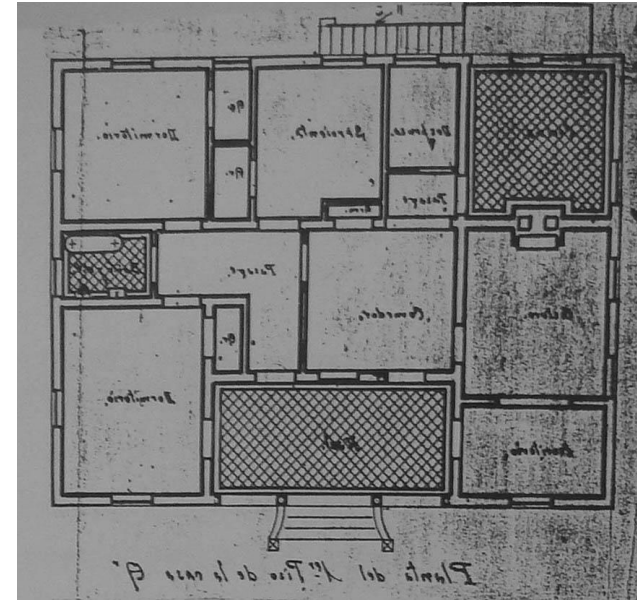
Planta do primeiro piso da Casa "A", Imagem espelhada. Arq. John Adams, maio de 1917. Fonte: BRAGHIROLI, 2014, p.273.
